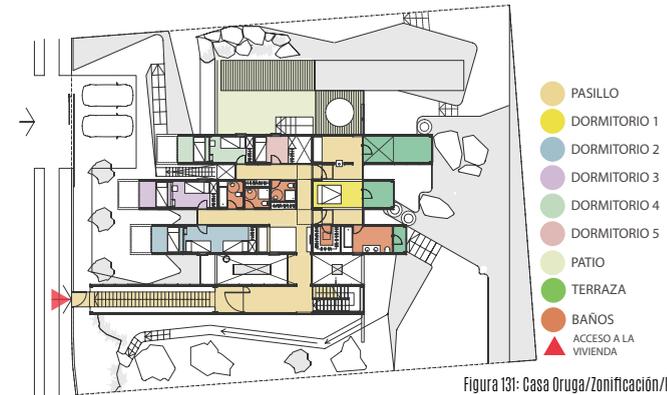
Casa Oruga/Zonificación/Planta Baja.
